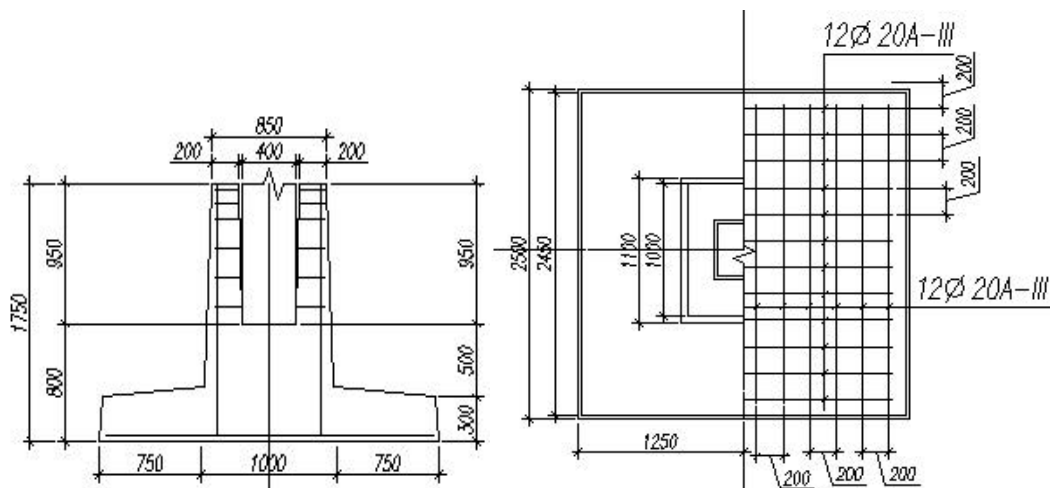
Геометрические размеры и армирование железобетонного фундамента под крайние ряды колонн каркаса
